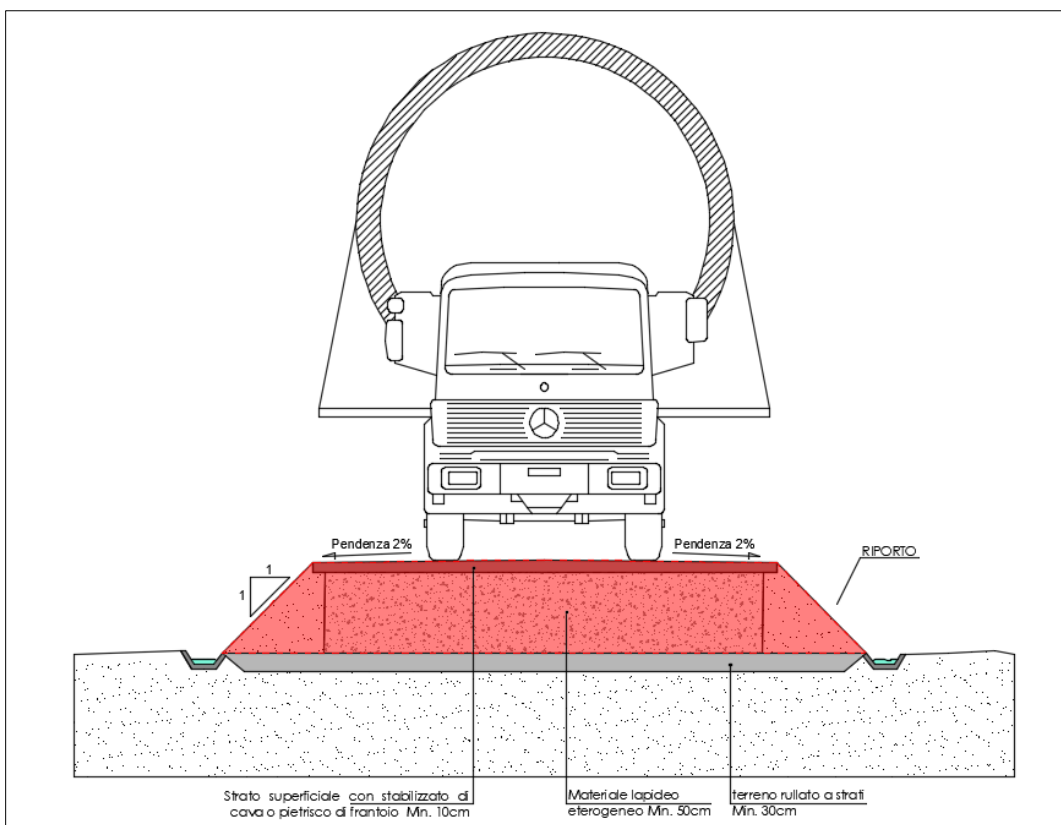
Sezione stradale tipo di nuova realizzazione in rilevato
